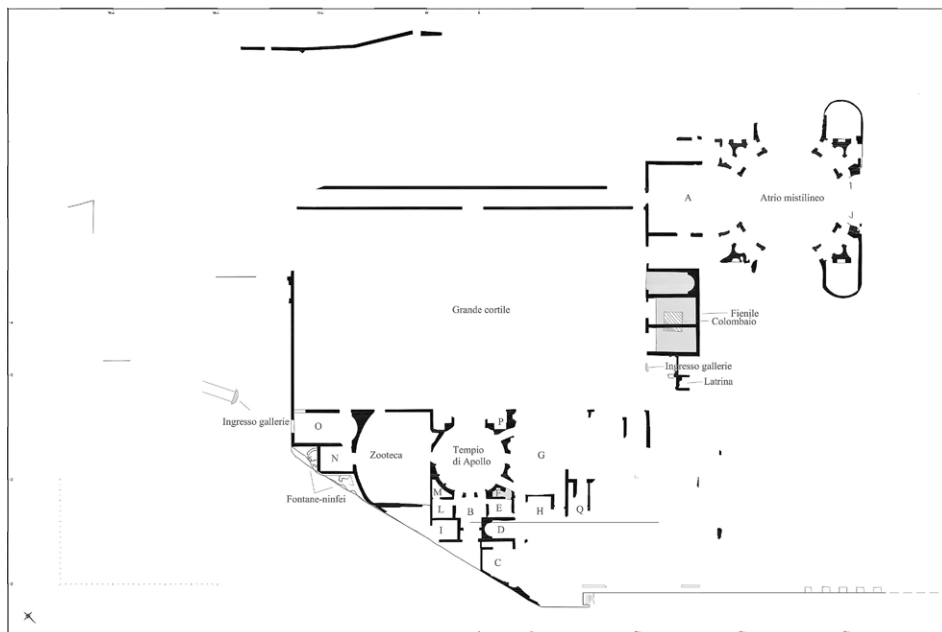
Villa Adriana, Accademia, pianta delle emergenze murarie (rilievo autore).
